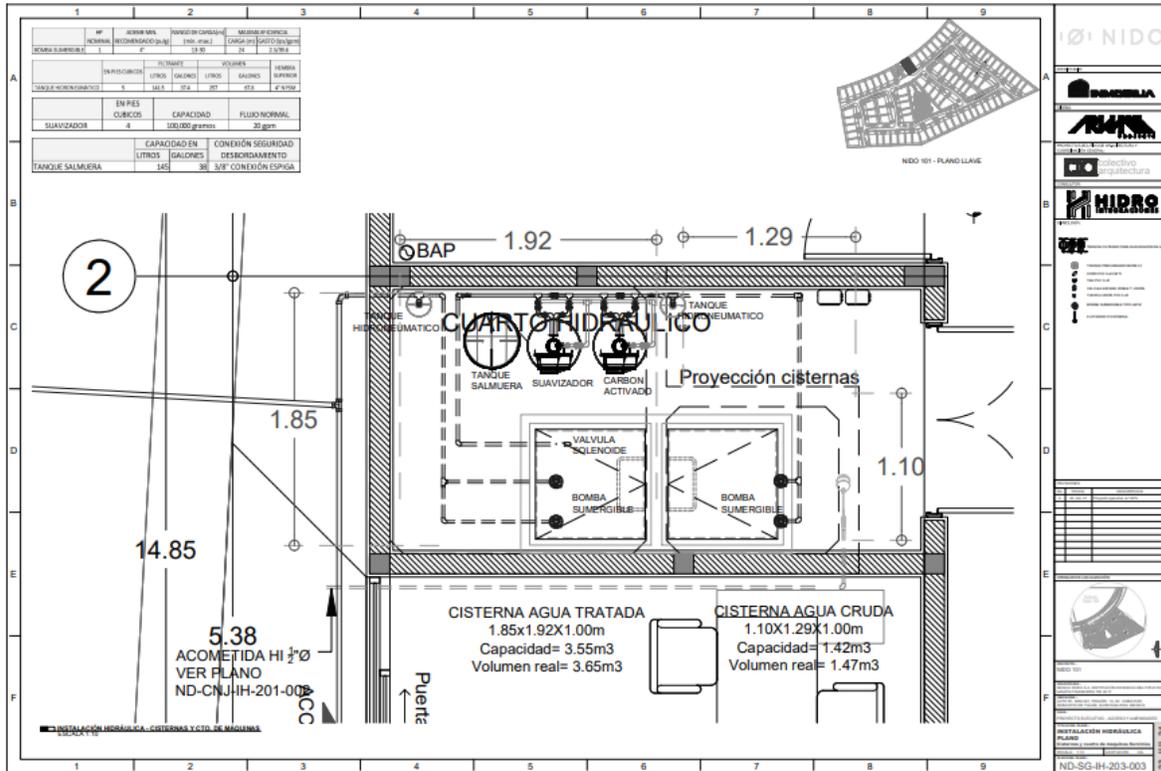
Plano de ubicación de las cisternas en área de servicios del proyecto.
